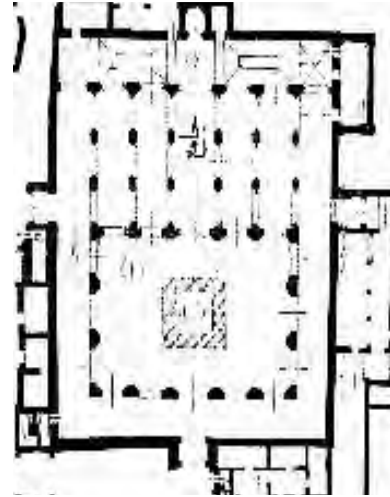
مسقط أفقي لجامع المواسين بمراكش
